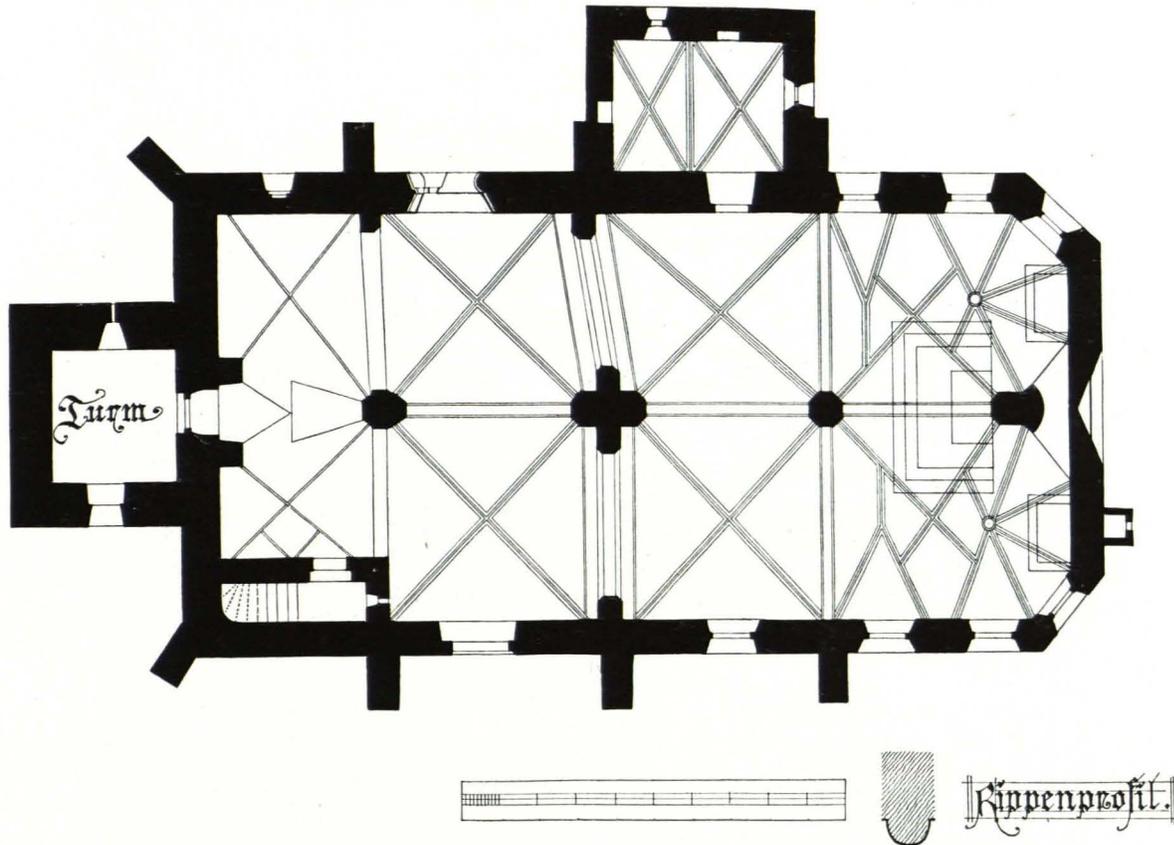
Leiben, Pfarrkirche, Grundriß 1 : 200 (S. 68)
